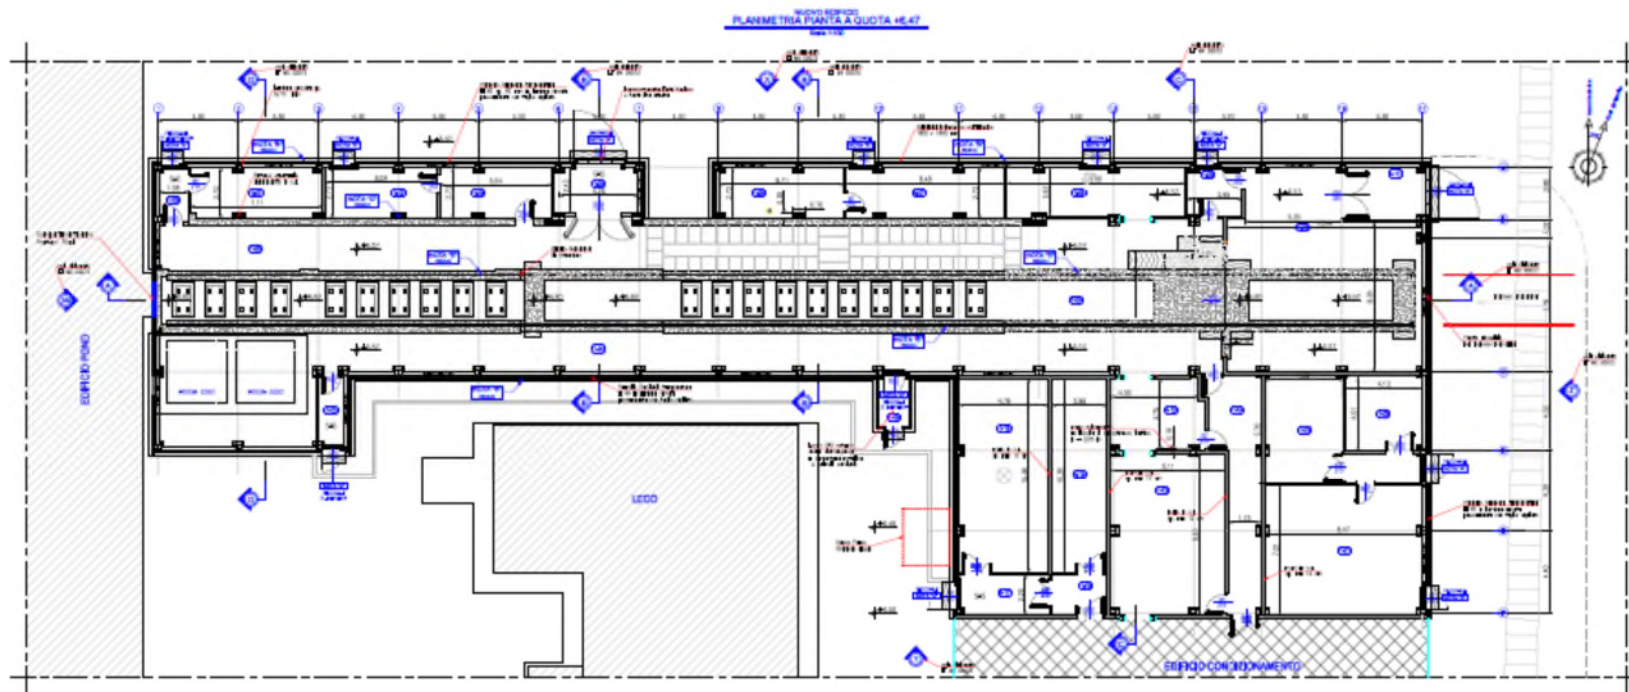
Pianta Edificio Estrazione Cernita e Caratterizzazione
